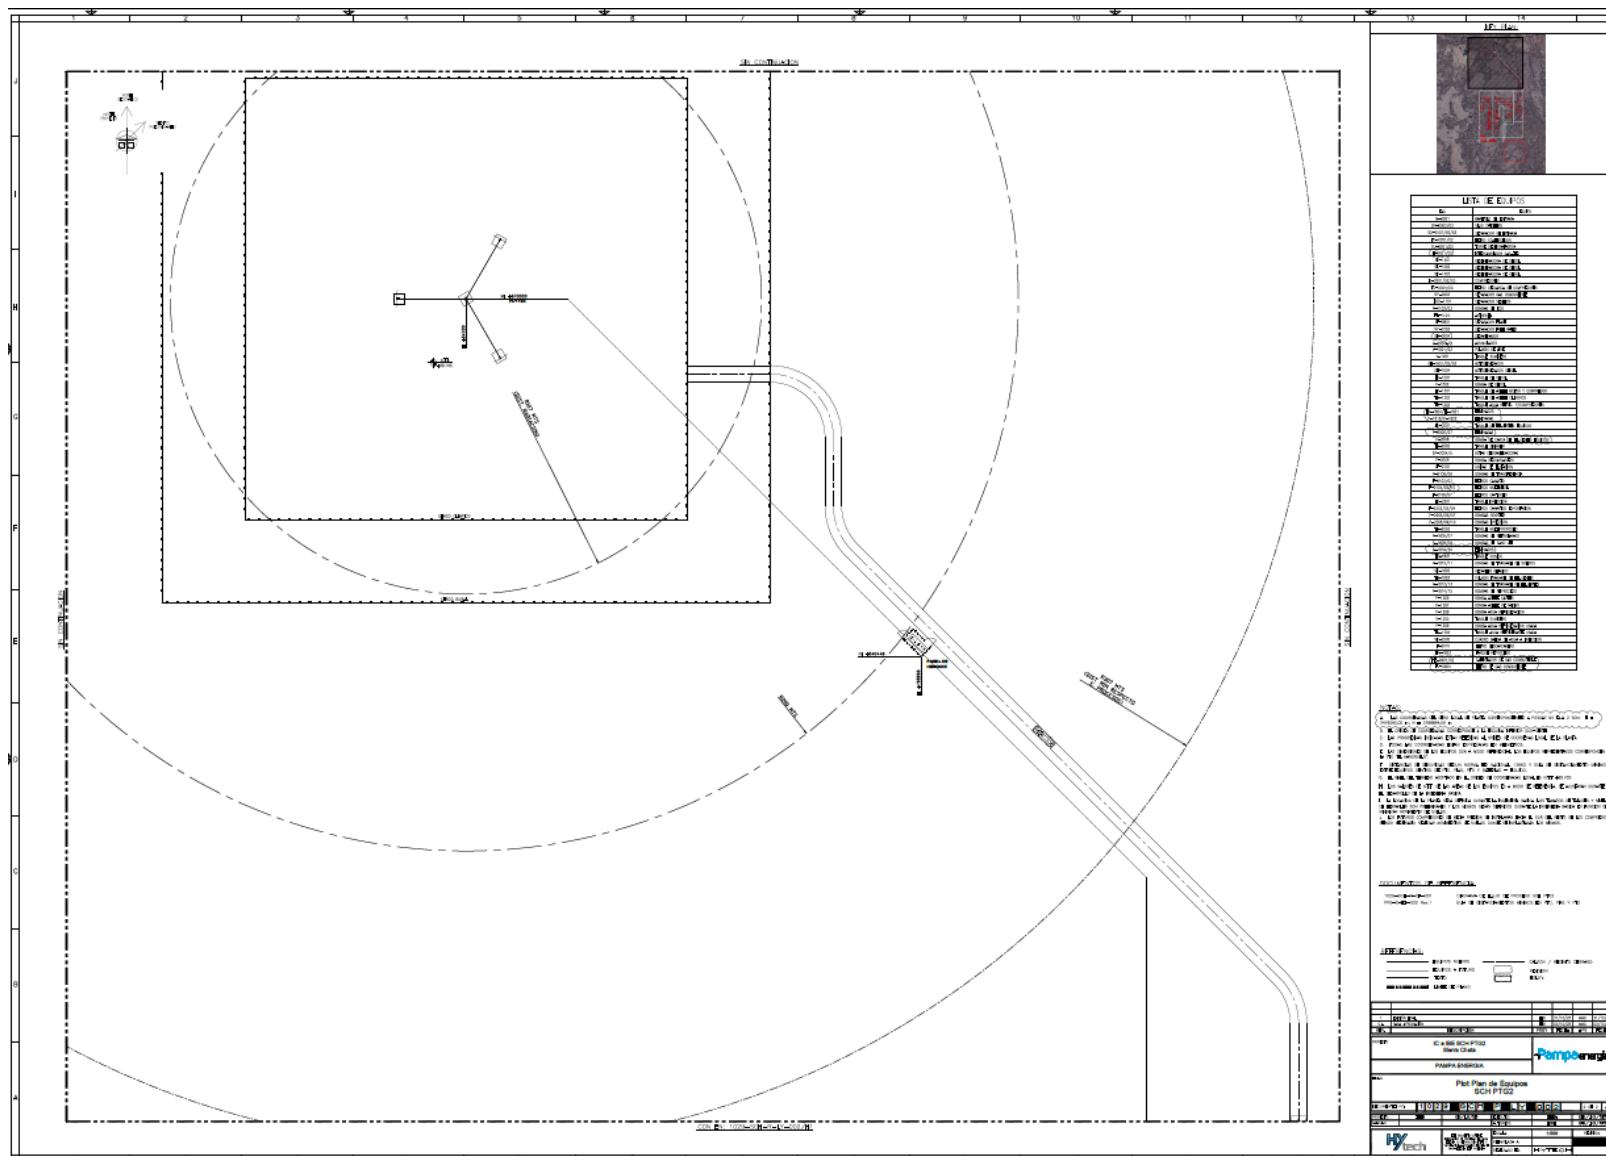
Lay out Plan de equipos en PTG 2 Norte (2/2).
